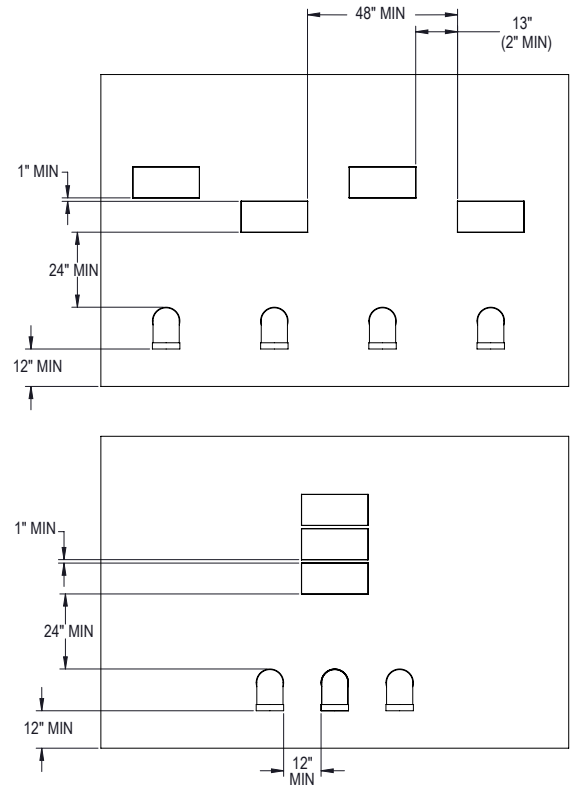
Dégage ment de ventilation horizontaux et verticaux
